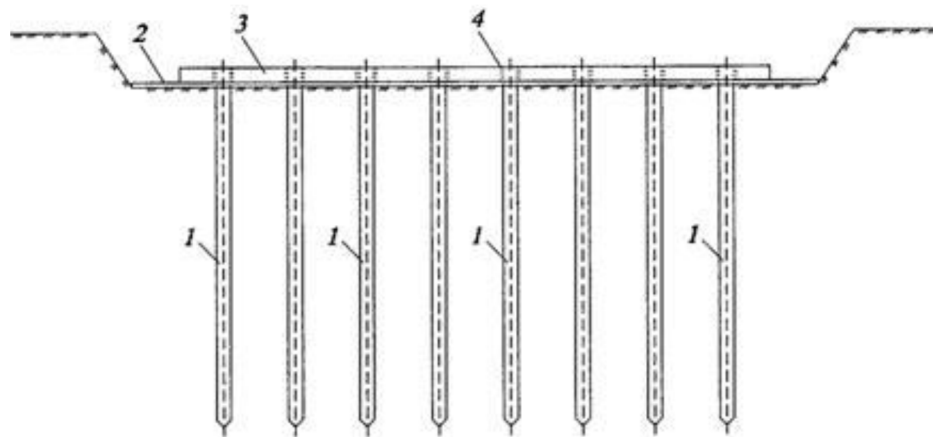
Спосіб зведення плитно-пального фундаменту, запропонований Г.Ф. Пеньковським, І.І. Сахаровим та А.В. Єршовим: 1 - палі; 2 - спланована поверхня дна котловану; 3 - монолітна залізобетонна плита; 4 - зазор навколо палі
